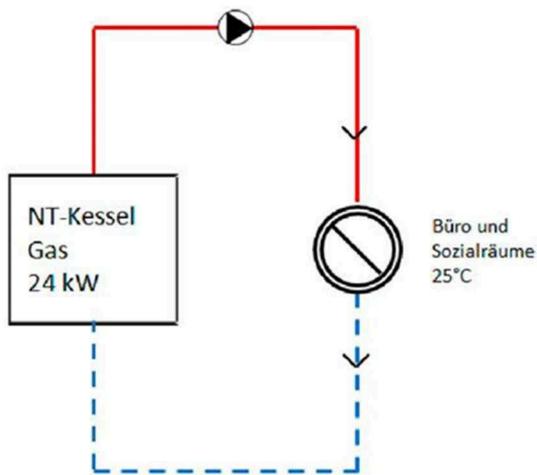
Schema Wärmeversorgung, Bürogebäude Außenbezirk Köln
